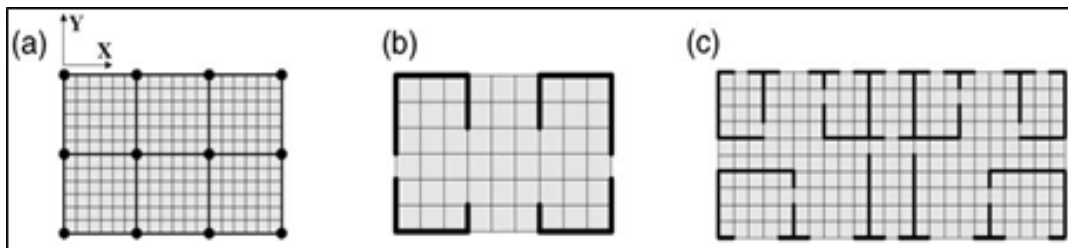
Estructuras ejemplo con un diafragma rígido. (A) Tipo de plano A, (b) Tipo de plano B, (c) Tipo del plano C.
